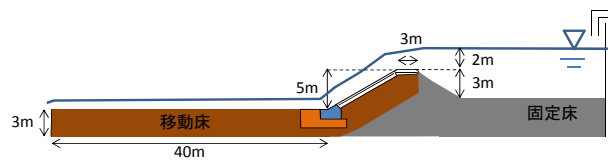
大規模実験の模型断面図（寸法は現地換算値）
